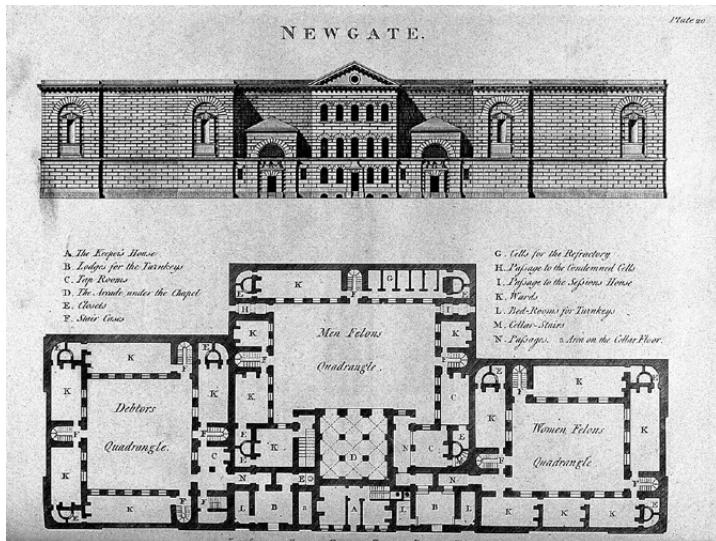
Planta y alzado de la prisión de Newgate (Londres). Tres patios.
